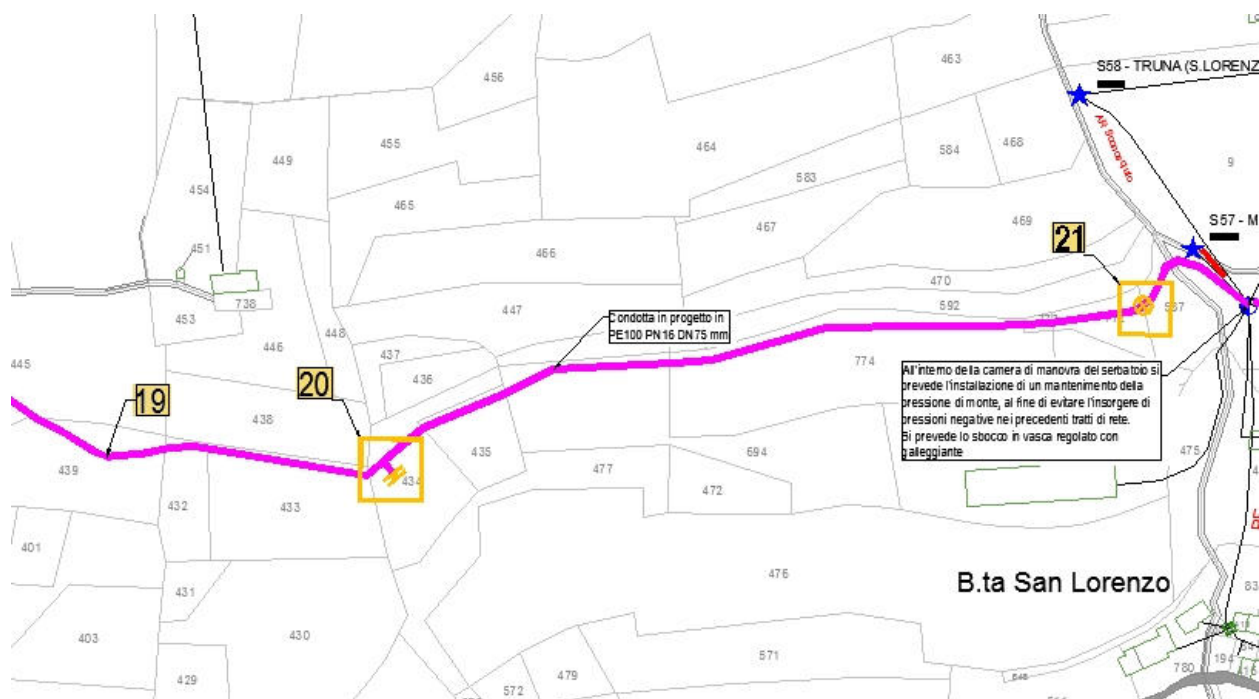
nuova condotta a progetto tra la Sezione 19 e la Sezione 21 su stralcio planimetria catastale.
